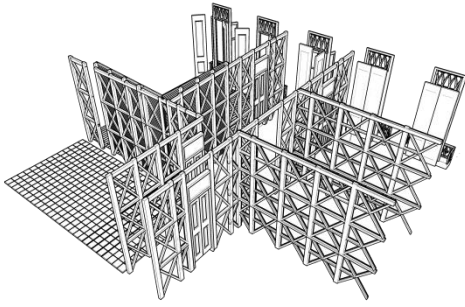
Desenho esquemático de apartamento sem paredes exteriores, expondo a construção (esqueleto), criação do autor.
